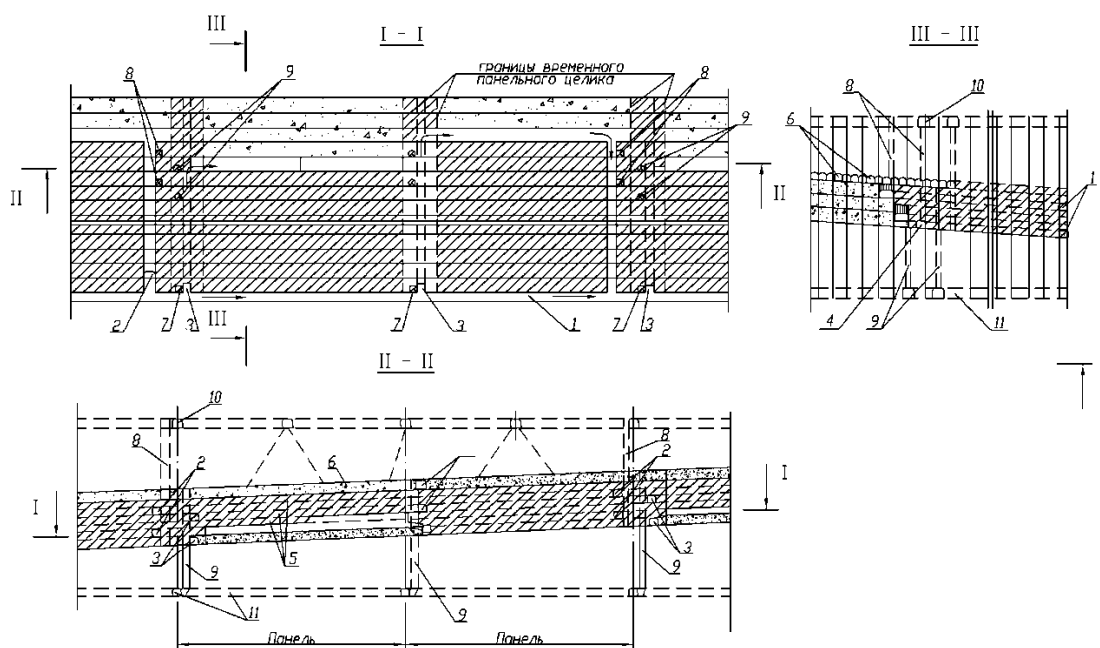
Сплошная система разработки с комбинированным порядком выемки слоев: 1 – транспортные штреки; 2 – вентиляционные орты; 3 – слоевые заезды; 4 – разрезные штреки нижнего слоя; 5 – очистные слои; 6 – выработки подкровельного слоя; 7 – воздухоподающие восстающие; 8 – вентиляционные восстающие; 9 – рудоспуски; 10 – выработки вент-закладочного горизонта; 11 – выработки откаточного горизонта.
